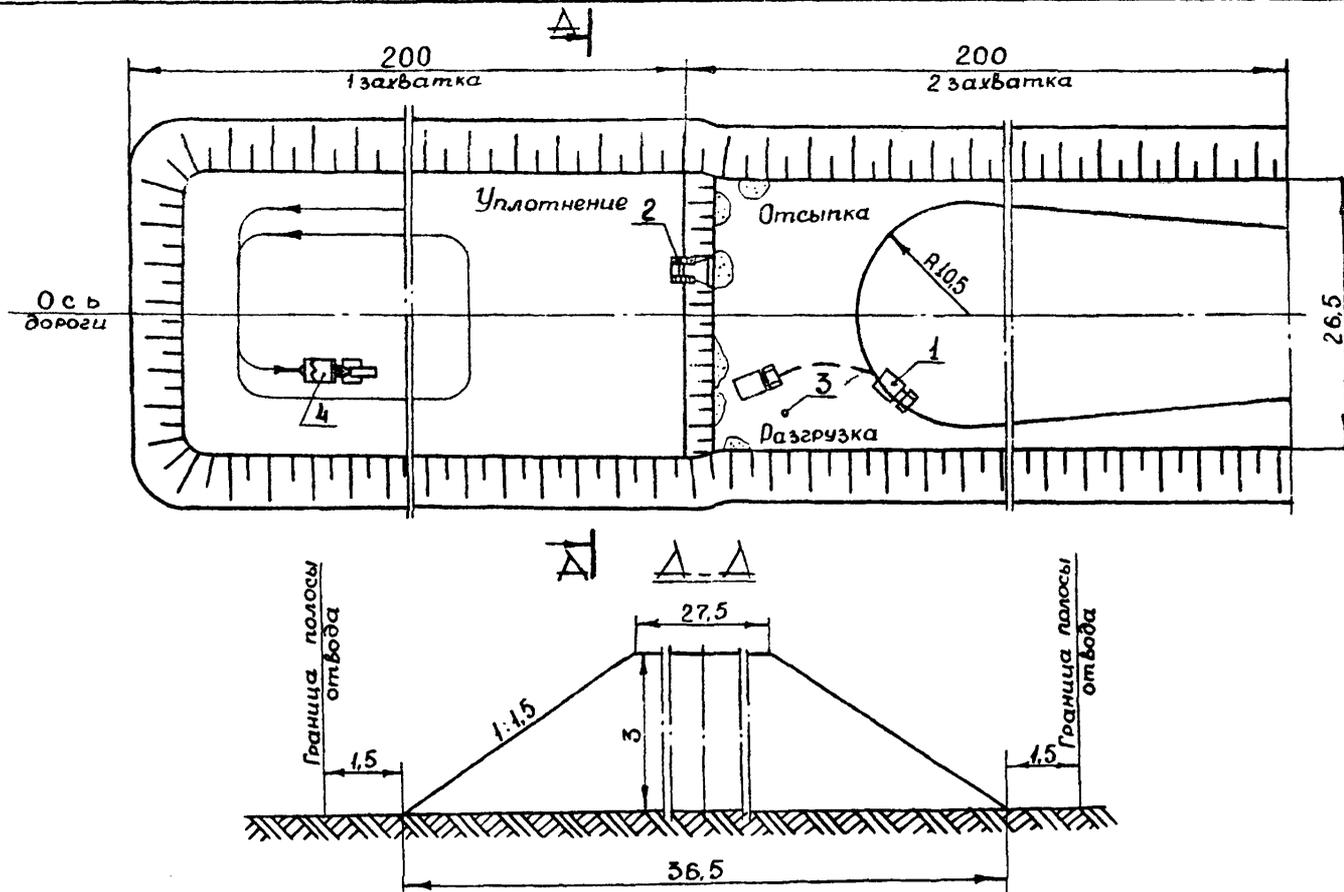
Схема отсыпки грунта при возведении насыпи дорожного полотна.
